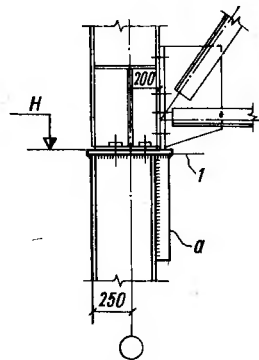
Оголовок колонны крайнего ряда кранового здания
